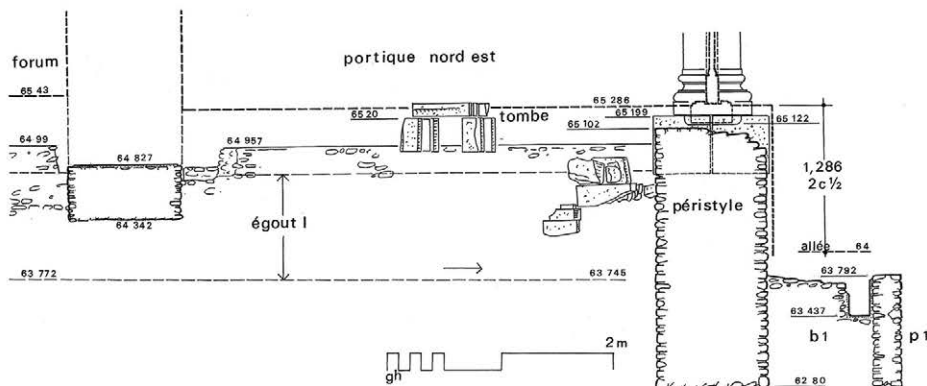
Coupe en travers sur le portique nord-est (G. Hallier).
